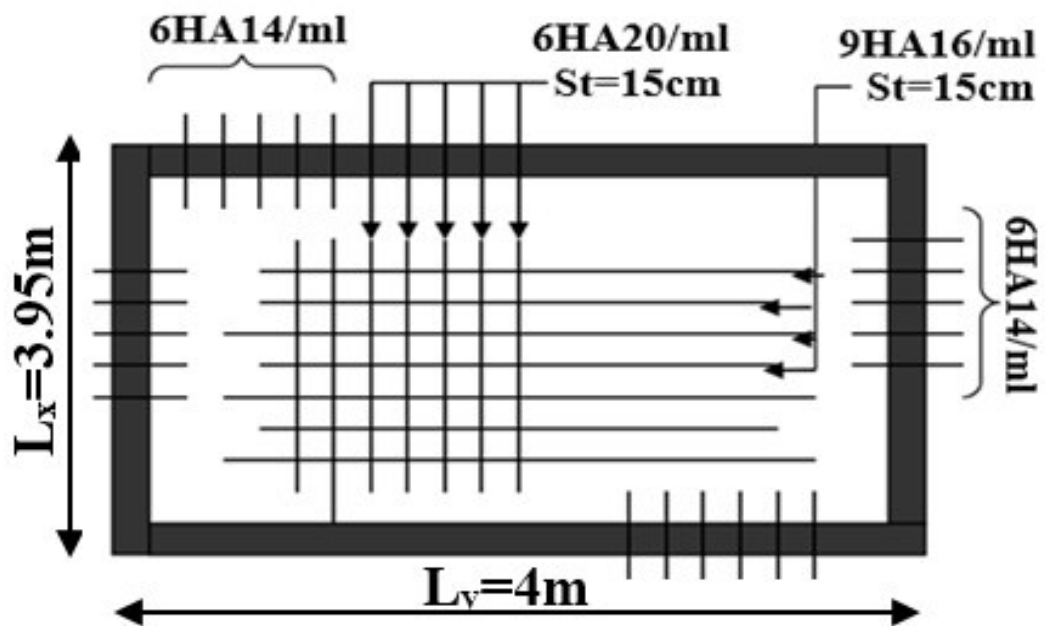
Schéma de ferrailage de la dalle de radier.
